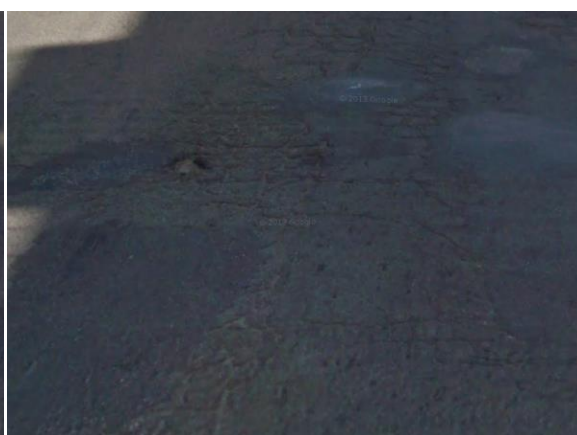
Panela, remendo e trinca do tipo couro de jacaré.
